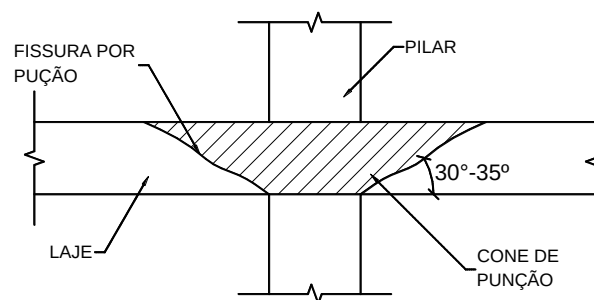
Laje apoiada diretamente em pilar (laje lisa).
